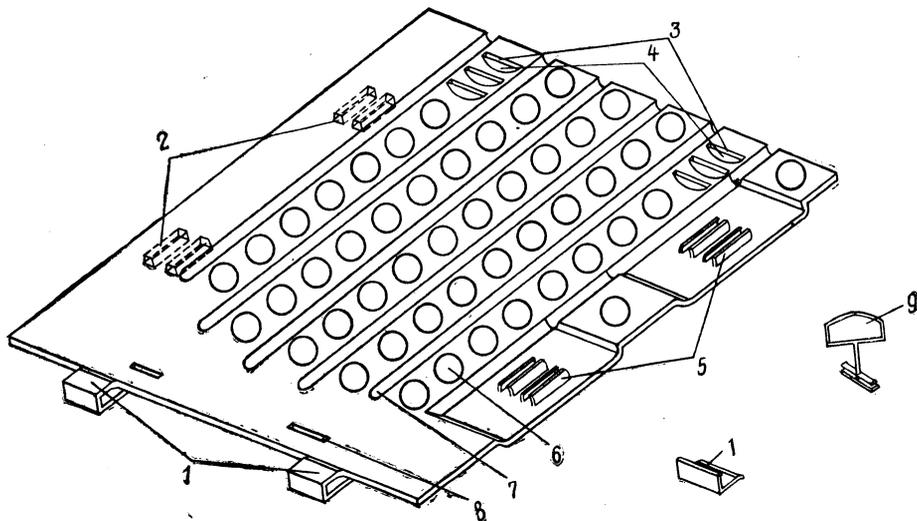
Конструкция плиты для колеейного и сплошного сборно-разборного металлического покрытия:
